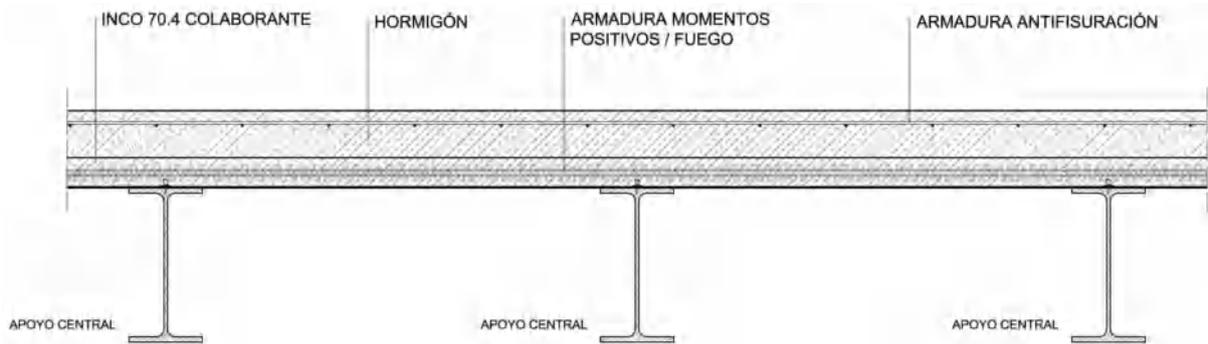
"Disposición de las armaduras de positivos/fuego sobre apoyos intermedios"
